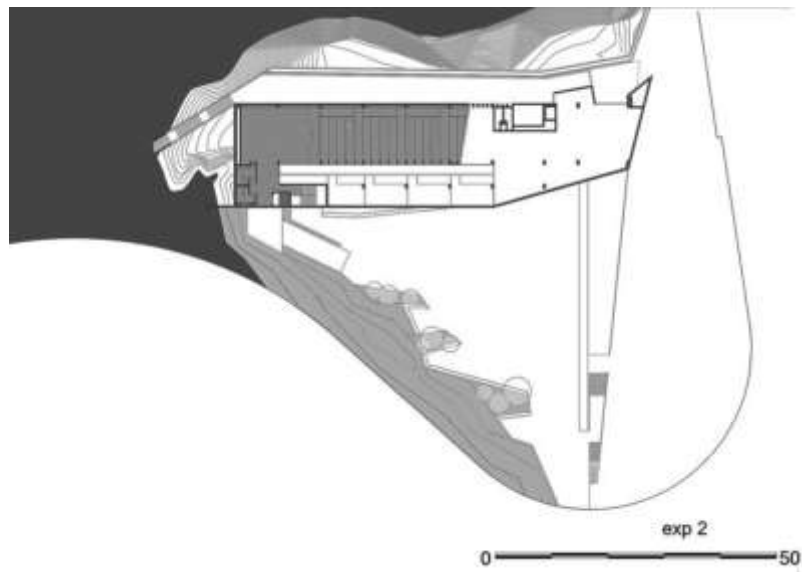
LUM. Planta Lugar de la congoja. +7.10 m. Estudio Barclay & Crousse
